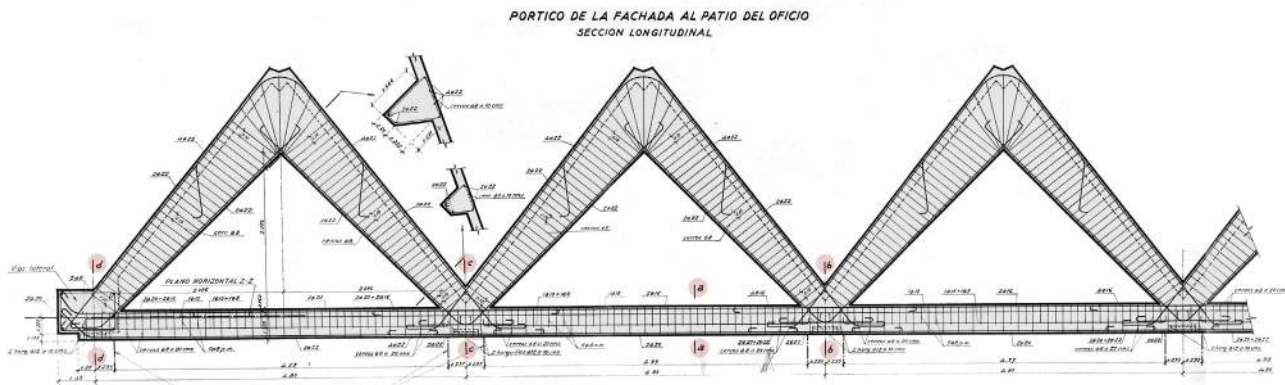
SECCIÓN LONGITUDINAL - FACHADA AL PATIO DE OFICIO
